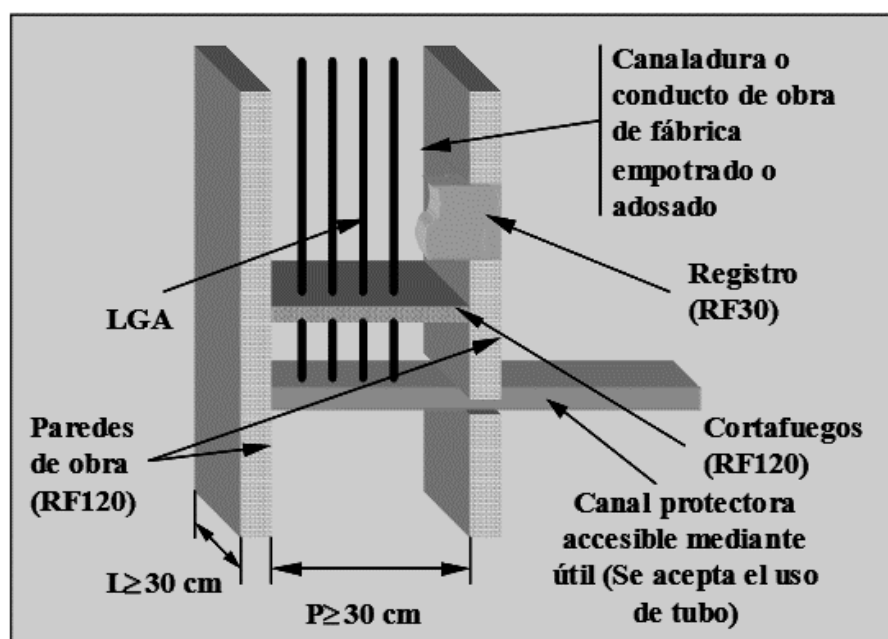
Ejemplo de la instalación de la LGA utilizando canal o tubo y conducto cerrado de obra
